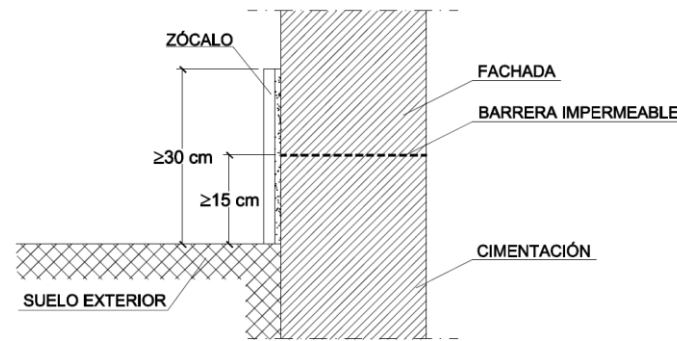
Ejemplo de arranque de la fachada desde la cimentación
